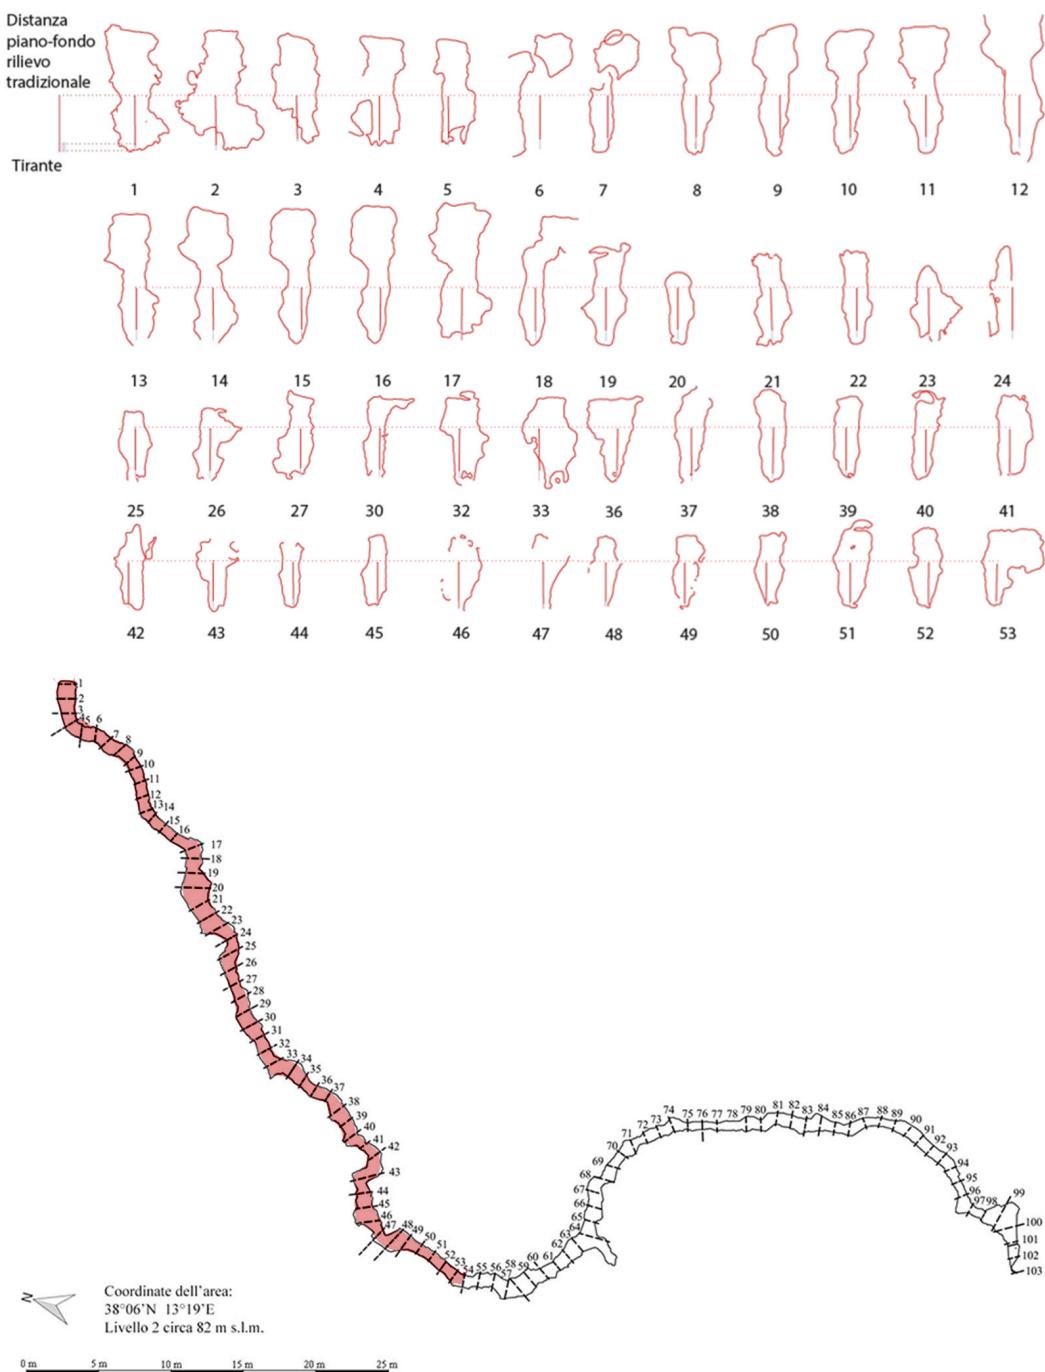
Restituzione grafica delle sezioni del qanat in pianta e in prospetto.
